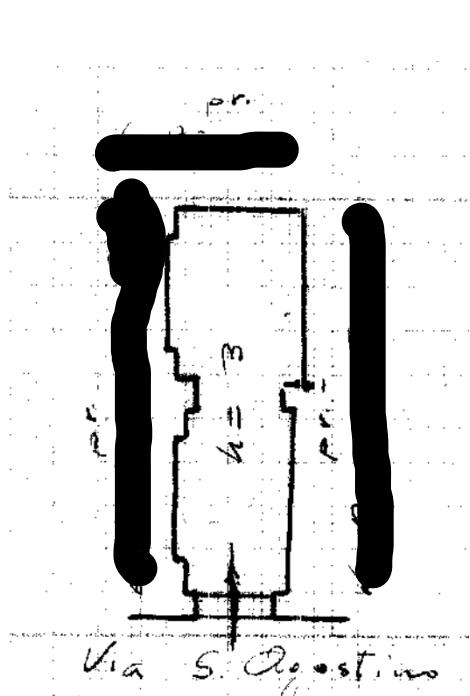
Estratto planimetria catastale del 06.12.1939.
